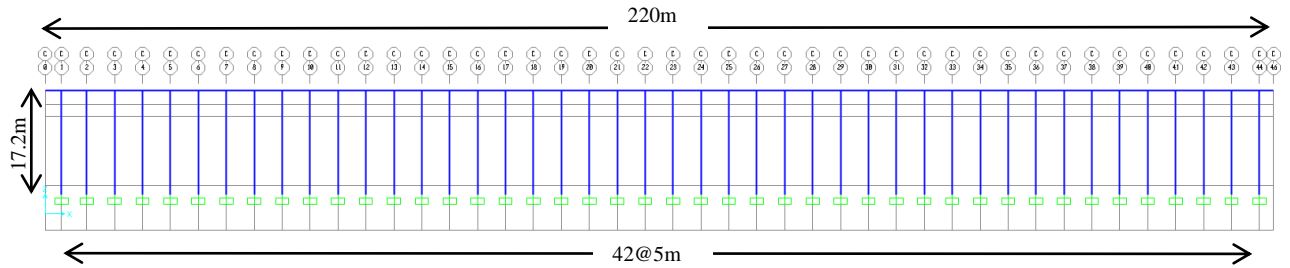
Vista en elevación del plano C de geometría, paralelo a plano X-Vertical.
